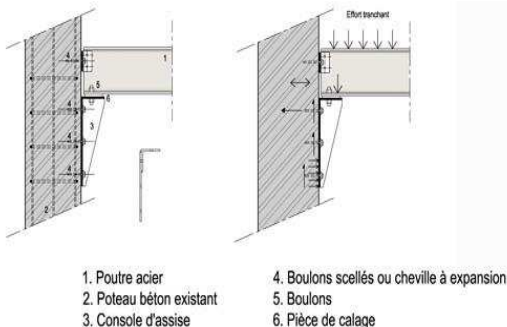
Détail d'articulation entre poteau en B.A et poutre en acier et plancher collaborant [www.detailconstructif.cype.com](http://www.detailconstructif.cype.com)
